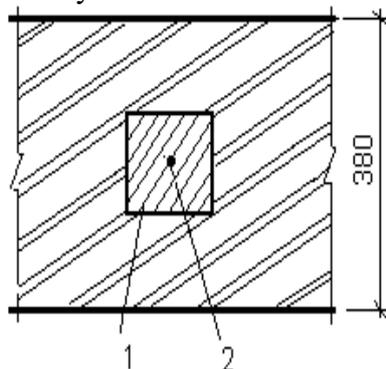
Конструкция внутреннего железобетонного сердечника. 1-железобетонный сердечник, сечением 120x120 мм; 2-арматура, диаметром $d=12$ мм, класса А-III.
